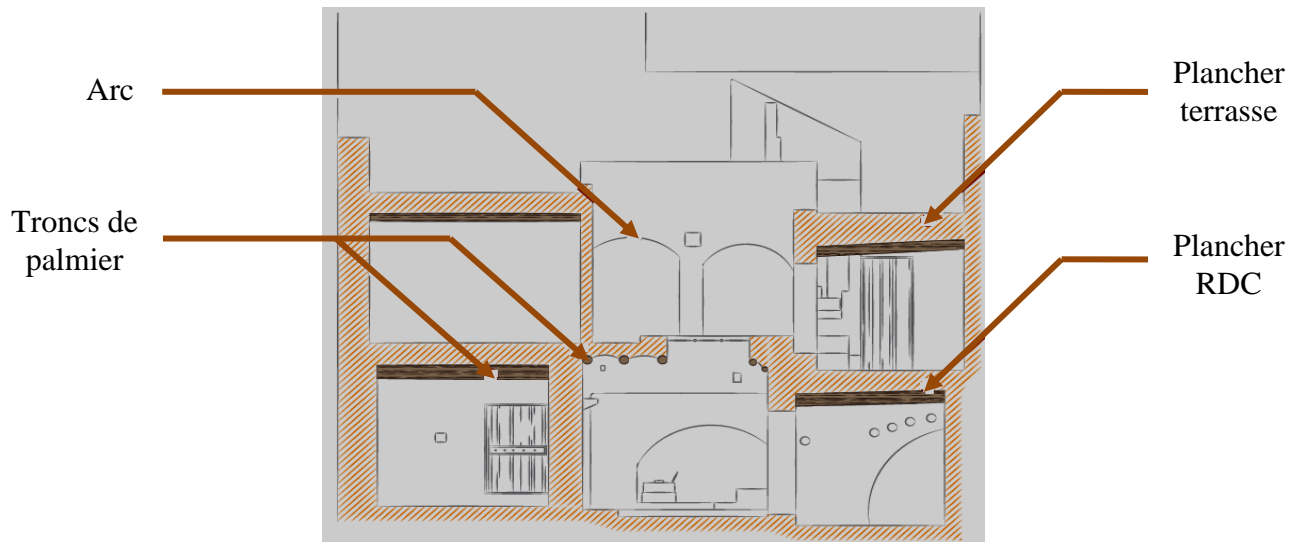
Coupe sur une maison traditionnelle mozabite montrant les différents planchers (OPVM, 2013)
